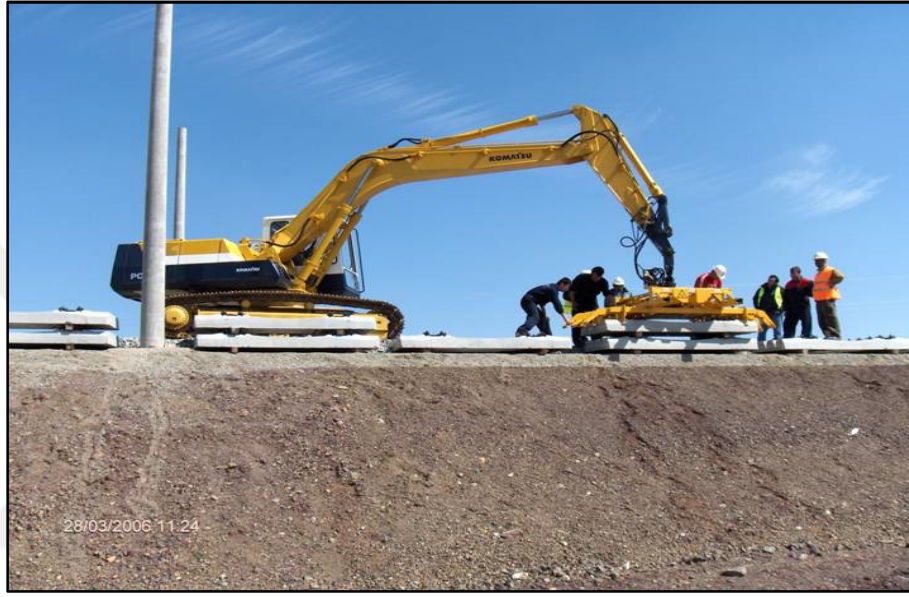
Yol serme makinası ile panellerin döşenmesi
